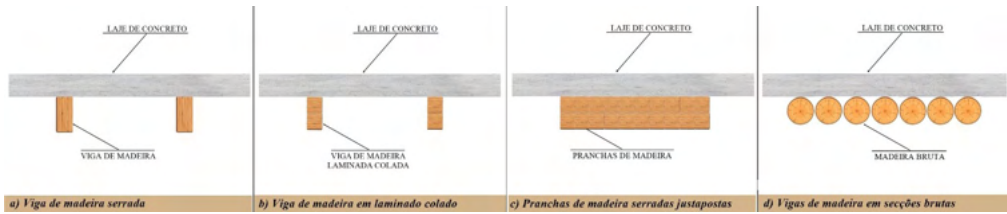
Detalhe de seções mistas em concreto/madeira
